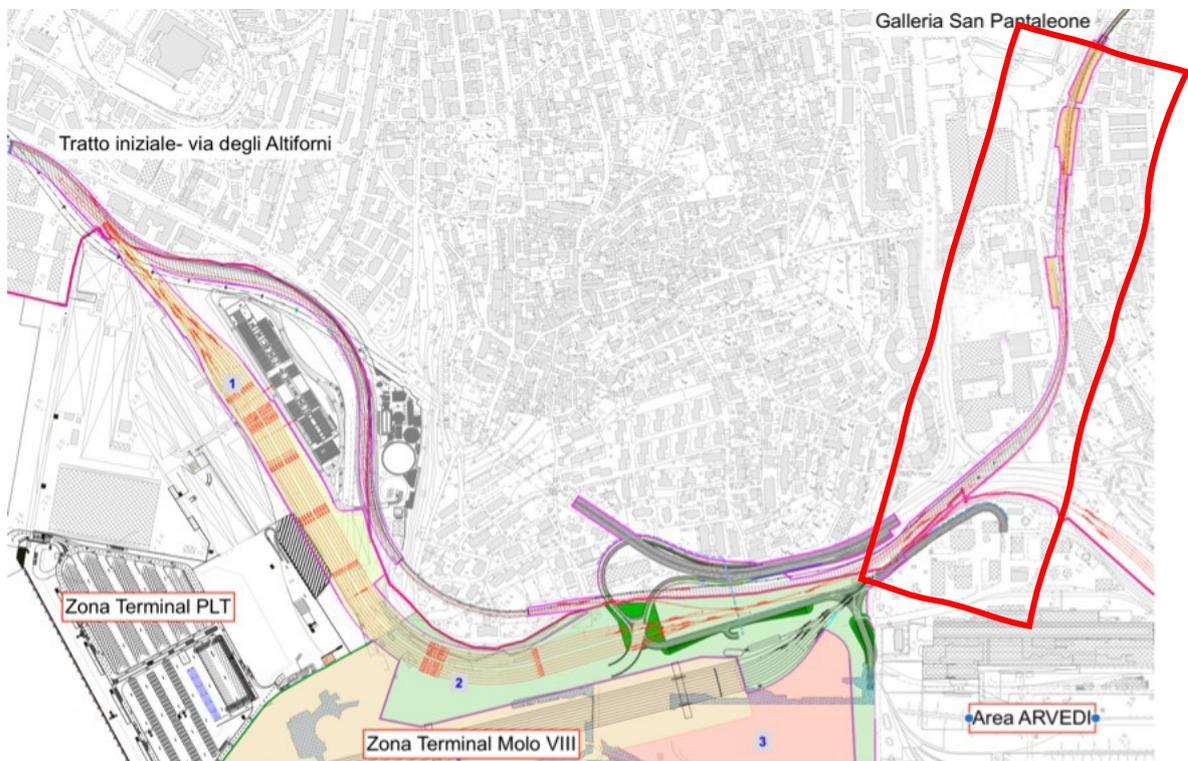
planimetria generale, con evidenziata la Sud-Est
